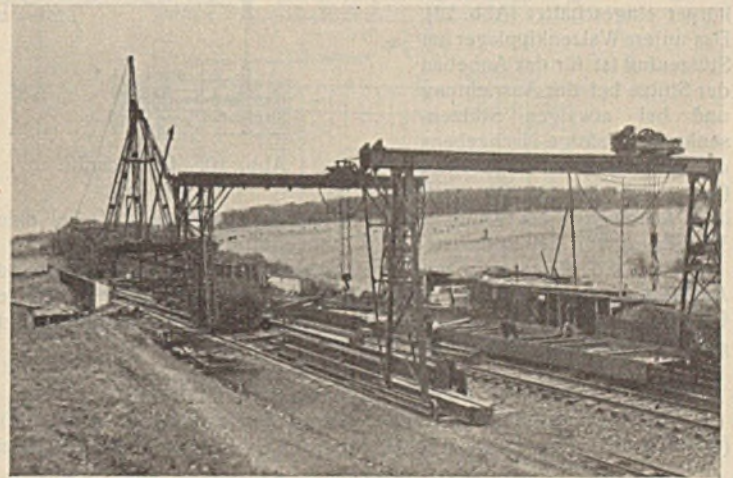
Zusammenbau der Trägerstücke auf der Zulage am Brückenkopf.
